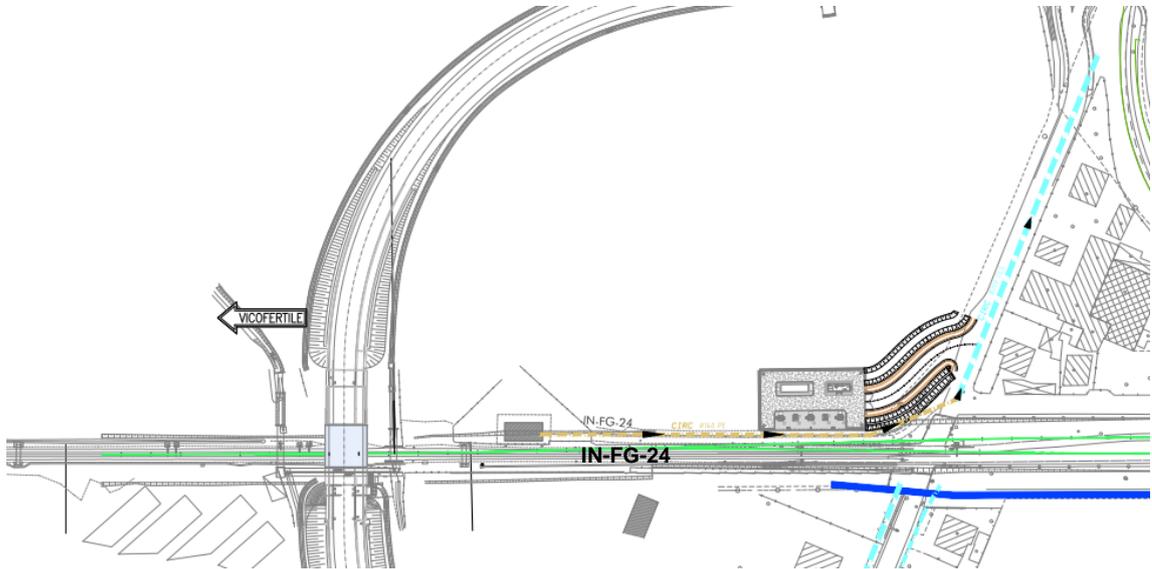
Risoluzione interferenze IN-FG-24 - Planimetria
